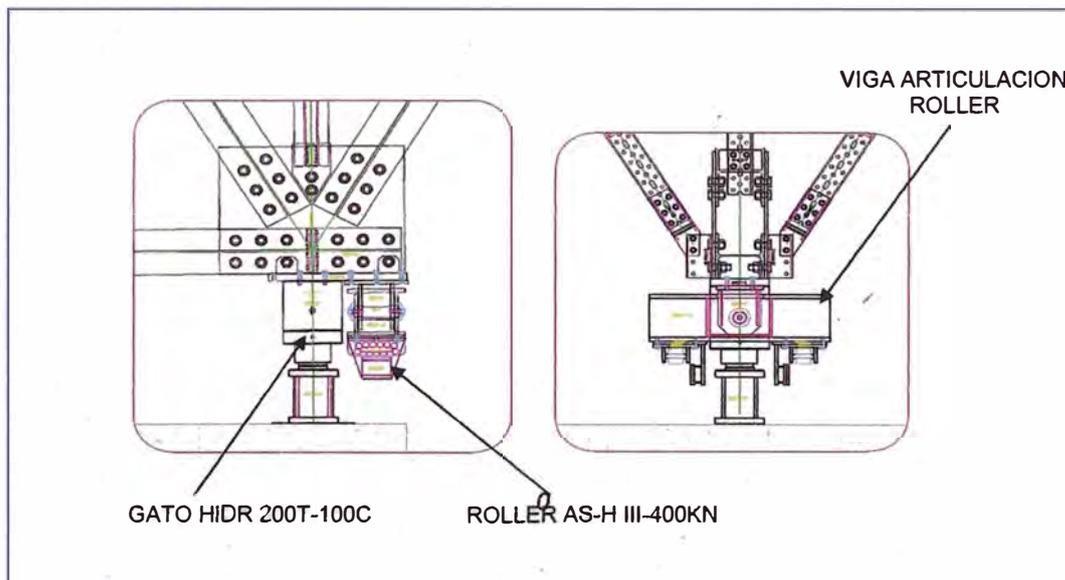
Vista Sección del Apoyo Delantero - Fuente: Elaboración Propia
